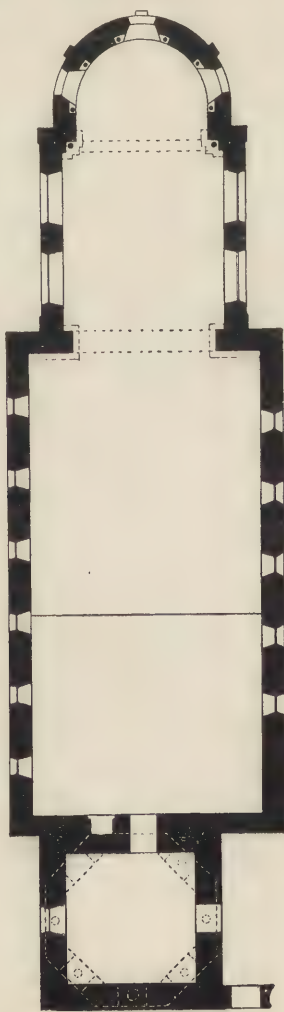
GRUNDRISS IN FENSTERHÖHE.
